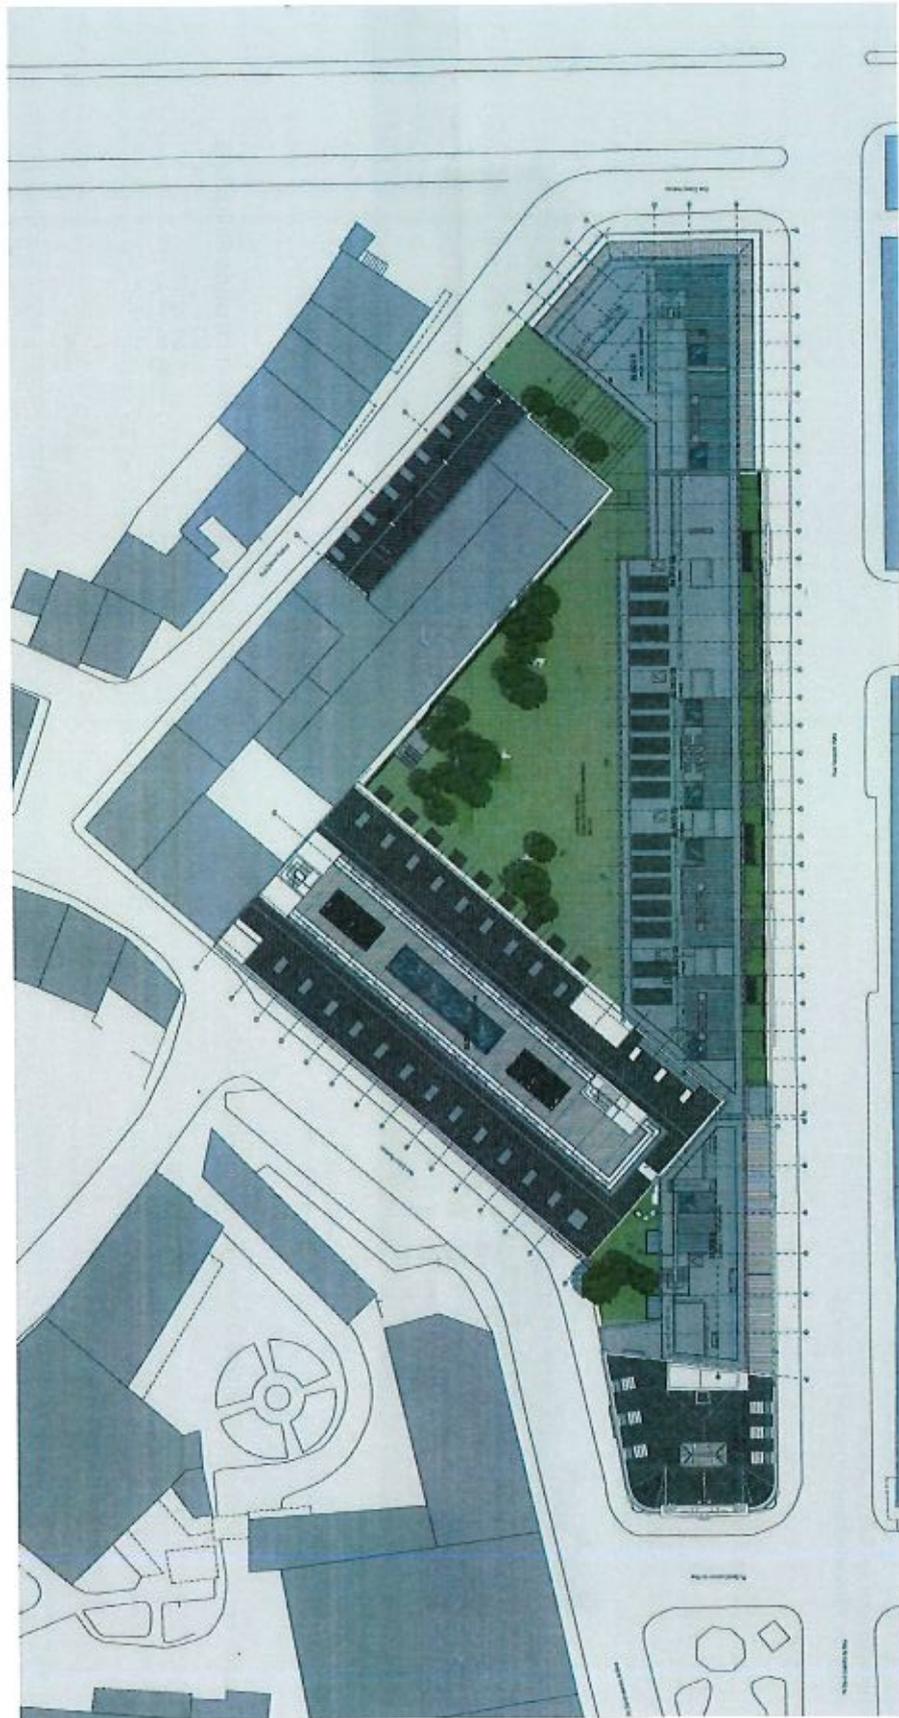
Desenho da Proposta/Projeto de Licenciamento, fevereiro de 2021. Plantas, Planta de Implantação 1.00
